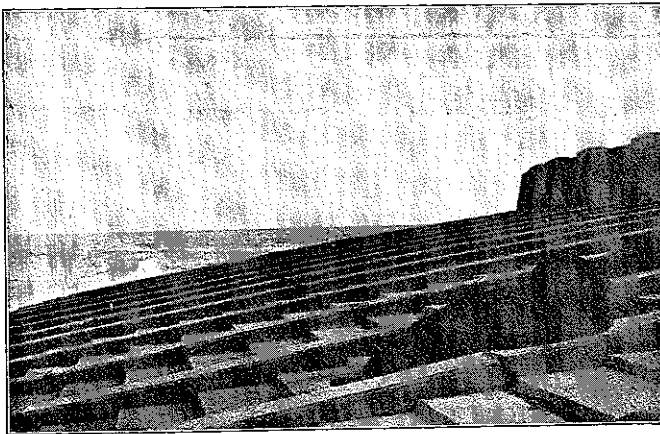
Betonglooing met dijksverhooging van beton aan en op den dijk te Zuricheroord in Friesland. De betonglooing, in 1912 gebouwd, kwam voor een deel nu en dan met zee-water in aanraking (Na den bouw van den afsluitdijk van de Zuiderzee zal dit deel grooter worden. De glooing houdt zich goed.)
